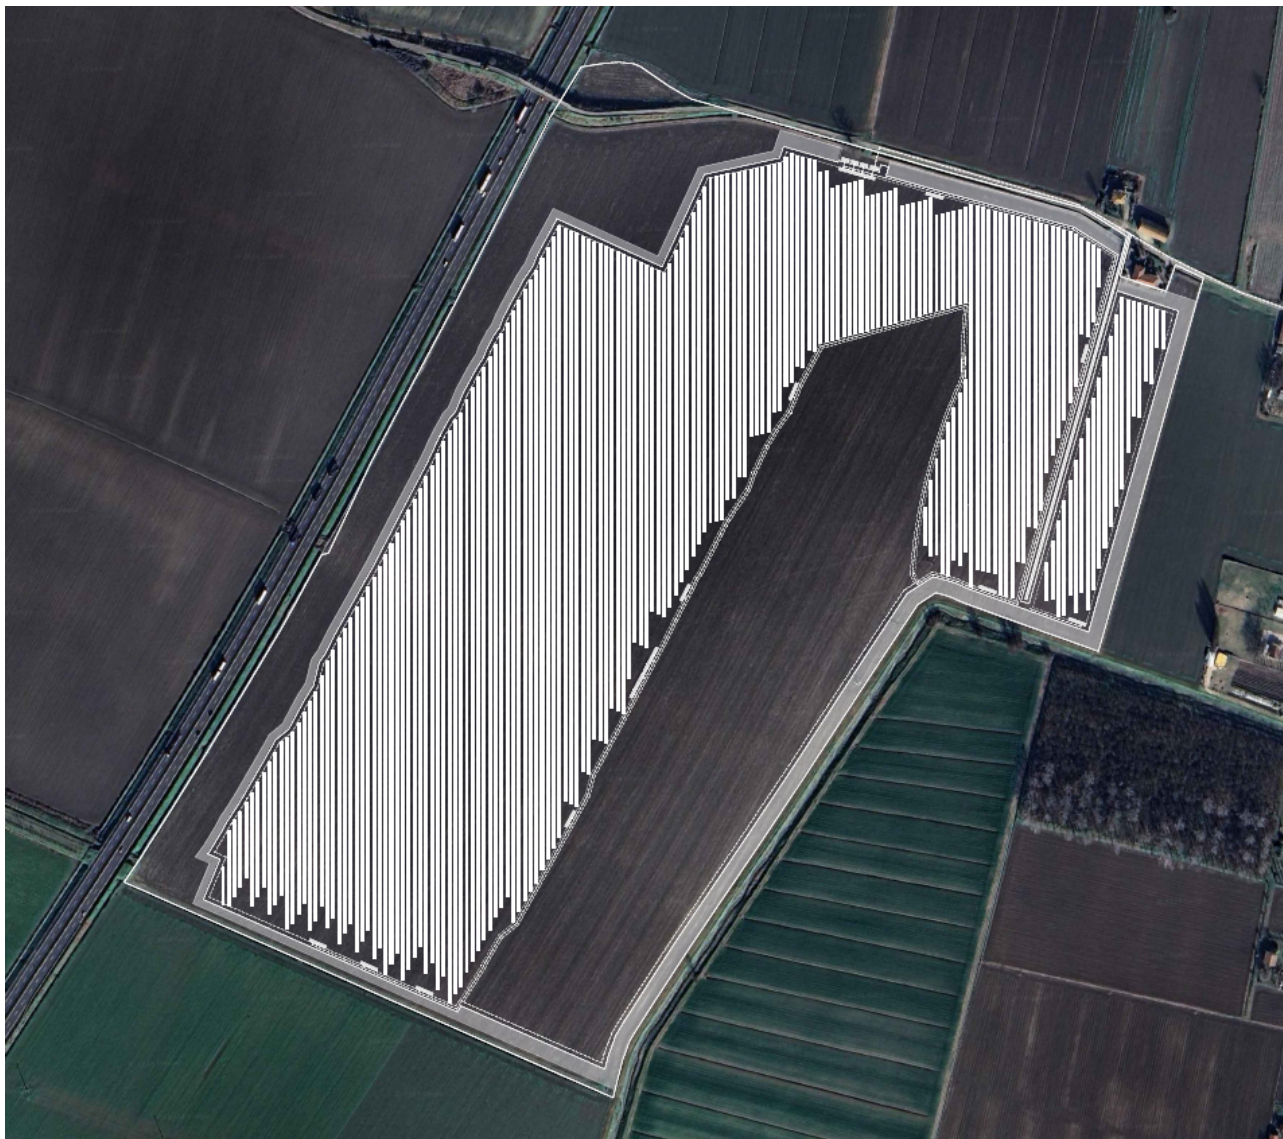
Layout impianto oggetto di istanza – NEOEN RENEWABLES ITALIA Srl
